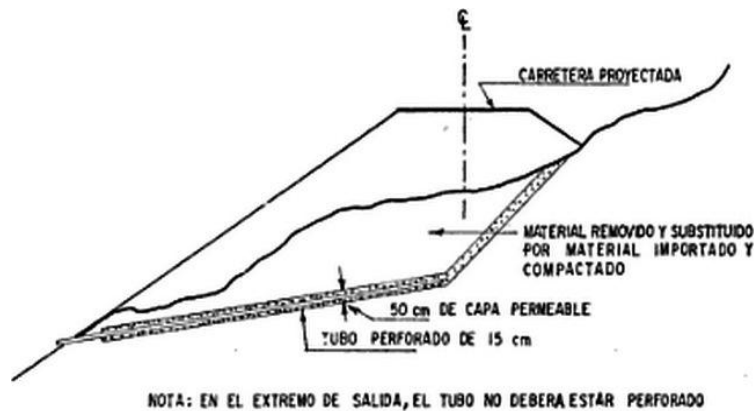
Remoción de material blando y colocación de una capa permeable bajo terraplenes.
